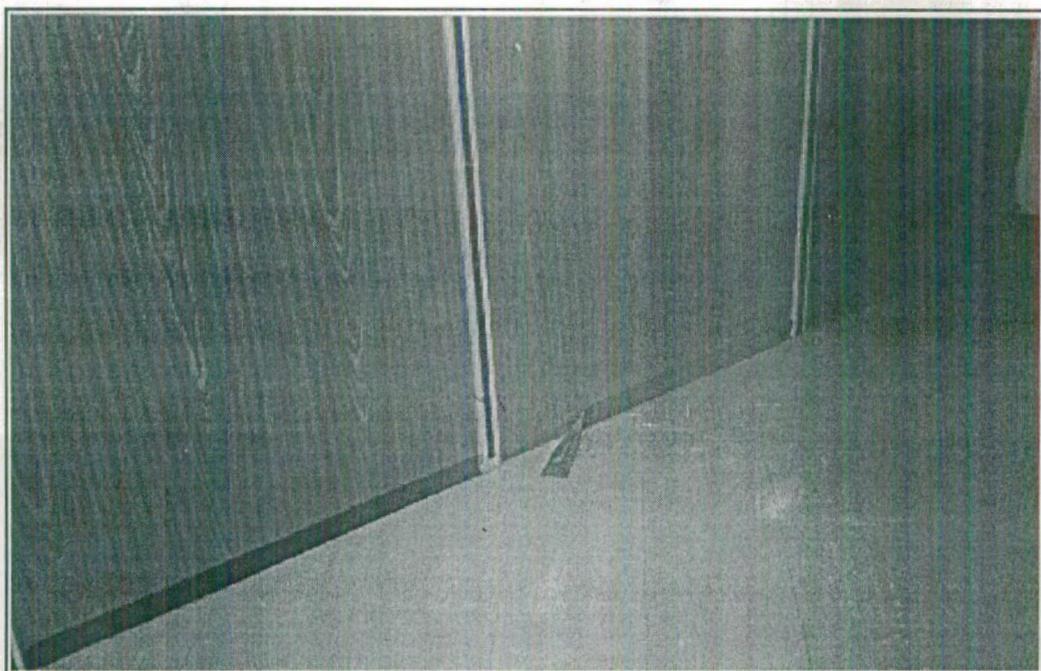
Estructuras de hormigón visto y divisiones interiores en zona de planta baja.
